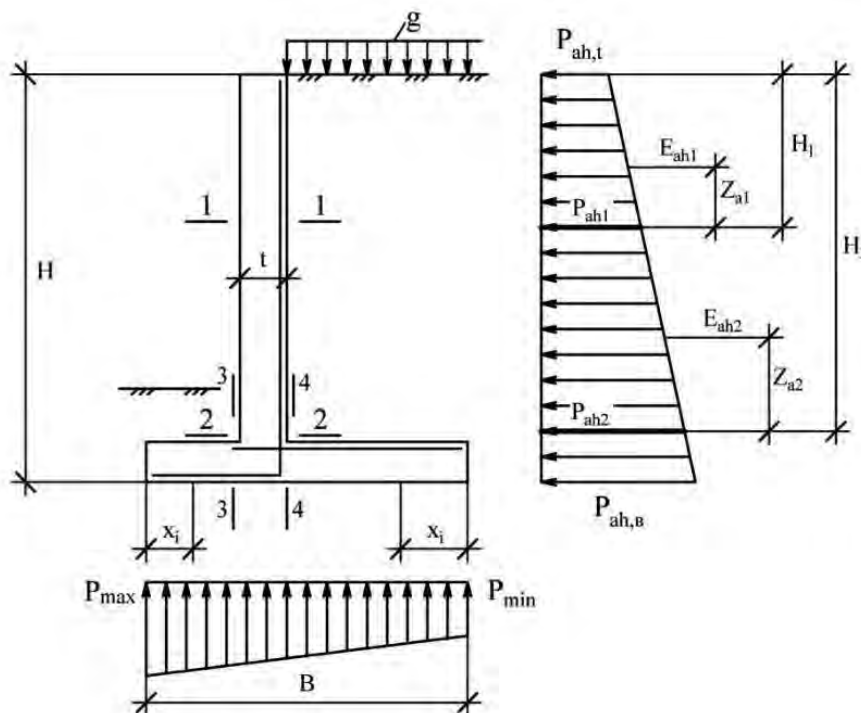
Схема действующих усилий на угловую подпорную стену и её армирование
